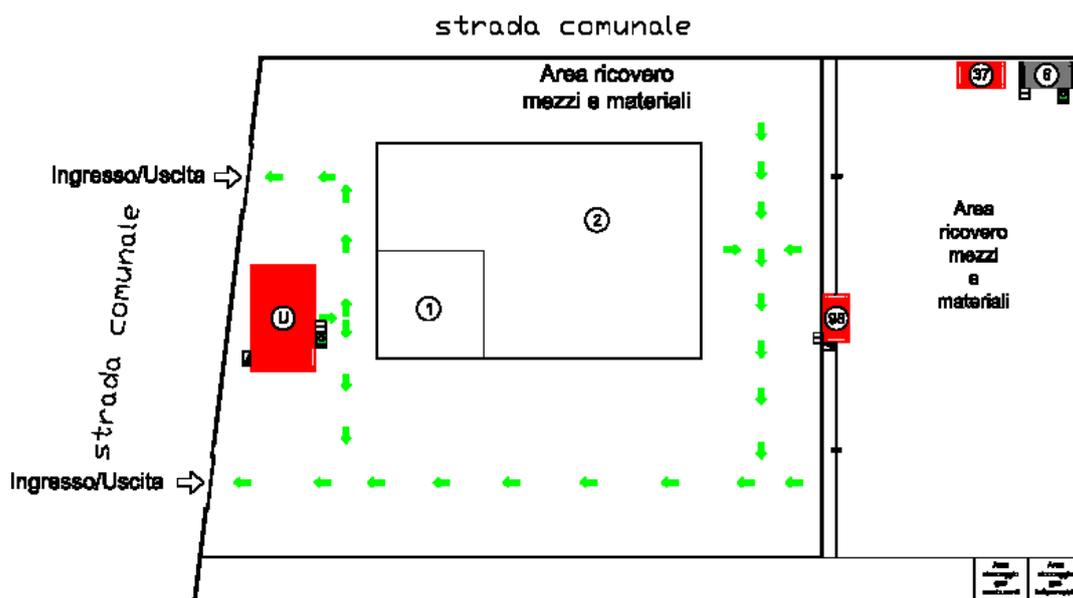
Planimetria Campo Base IMPRESA ESECUTRICE
